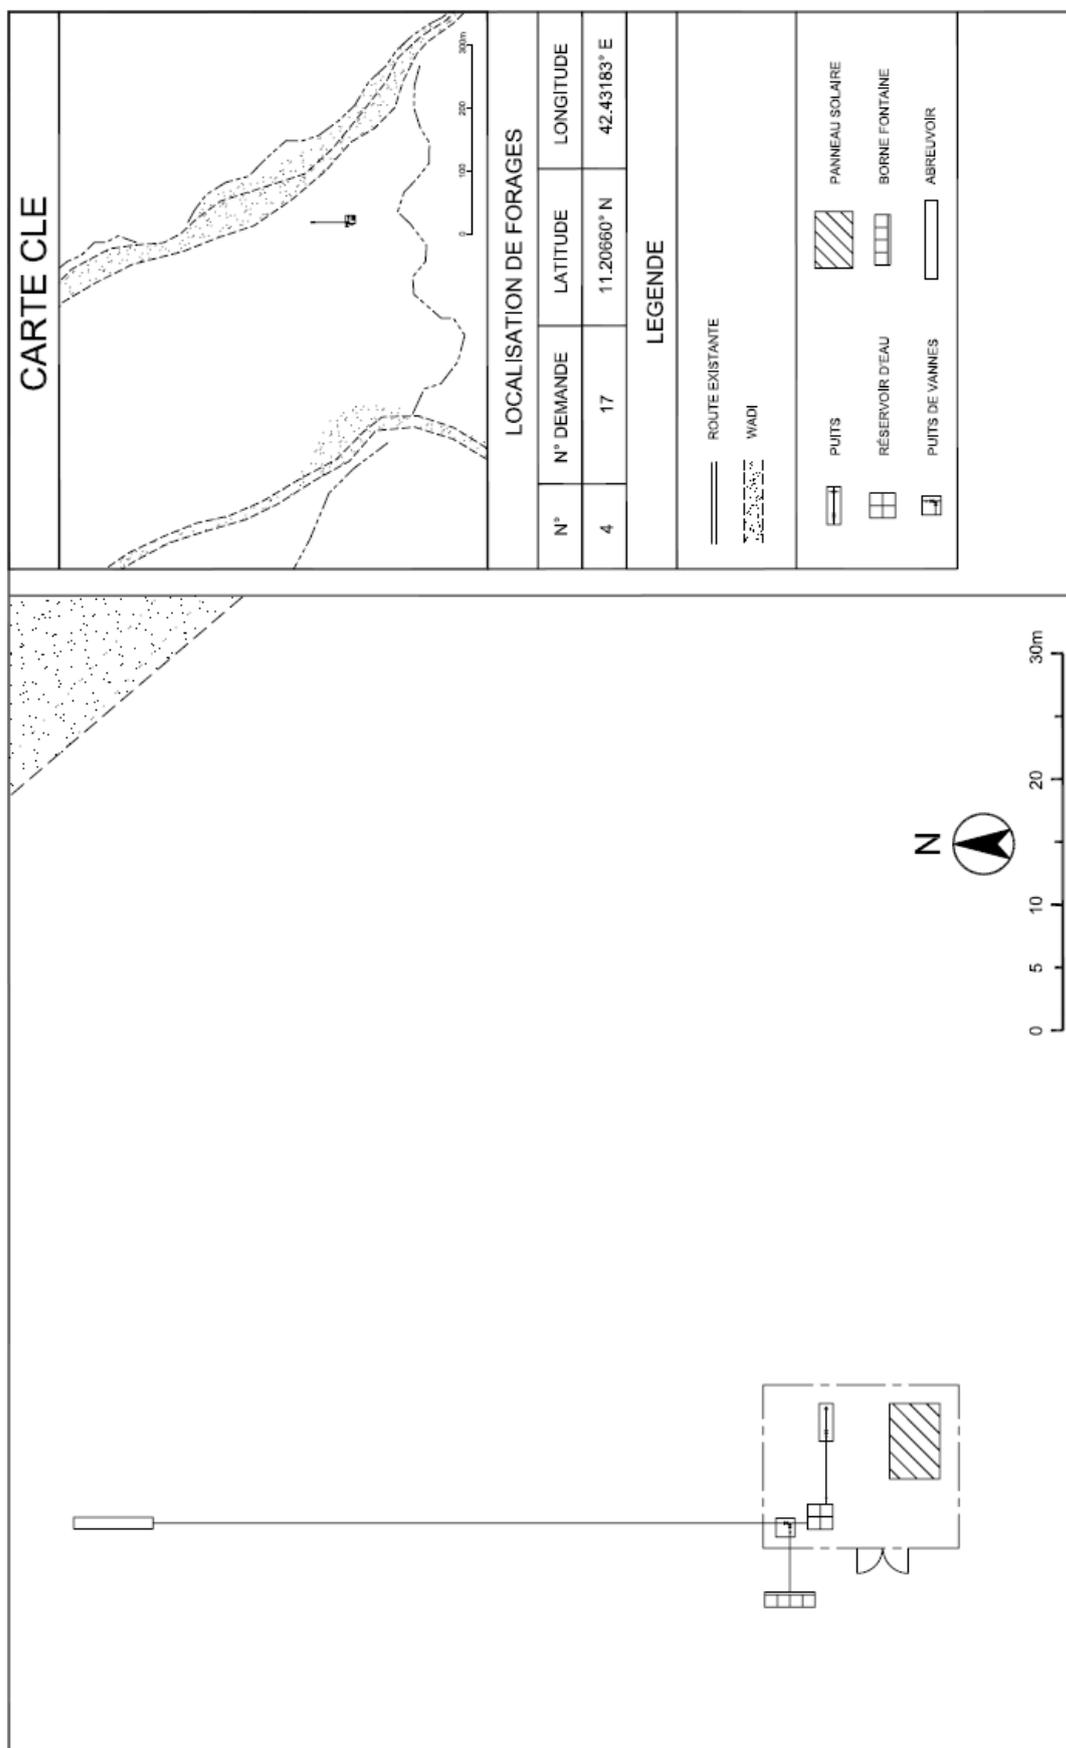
Plan d'implantation des installations (vi) [Mindil]
